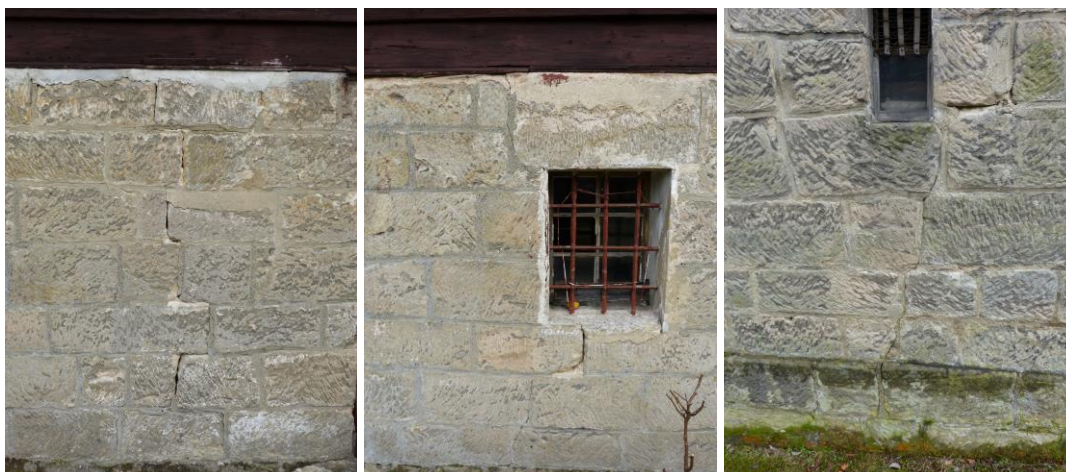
, 37 – porucha DH4; svislý pokles stěny v rádech jednotkách cm, špatné provedení stabilizace stěny, vyjmutá část napadeného vodorovného trámu a podlahové konstrukce
